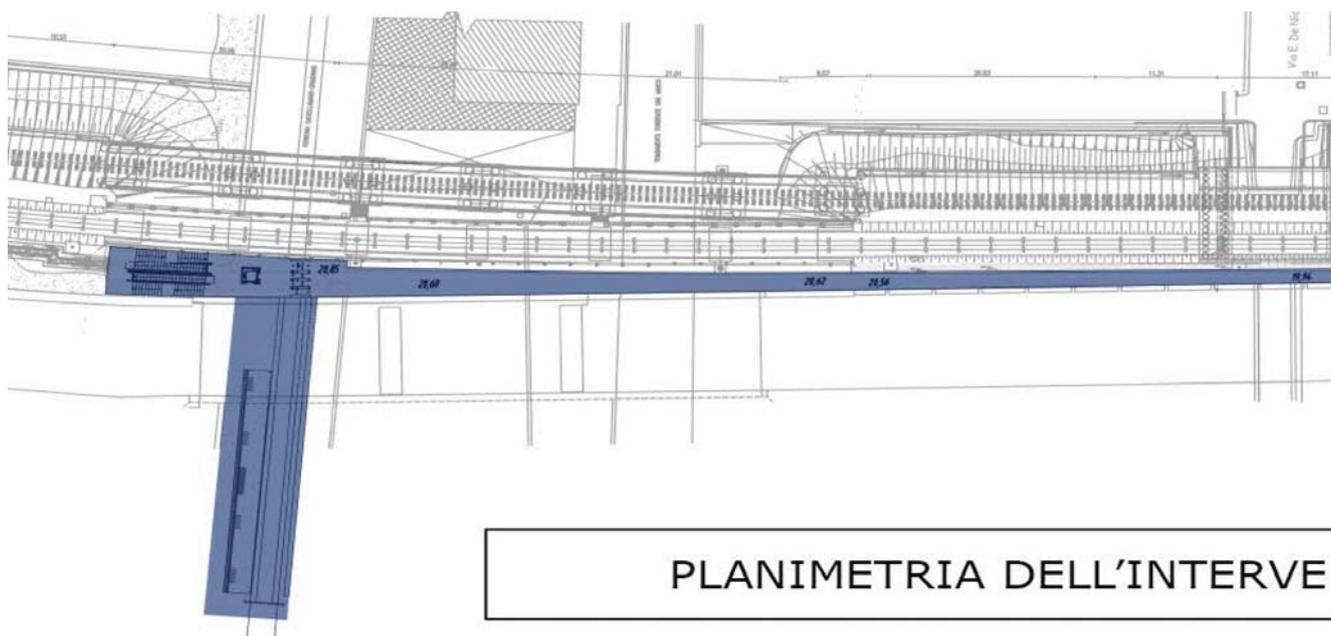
Progetto del nodo di interscambio: planimetria dell'intervento.
